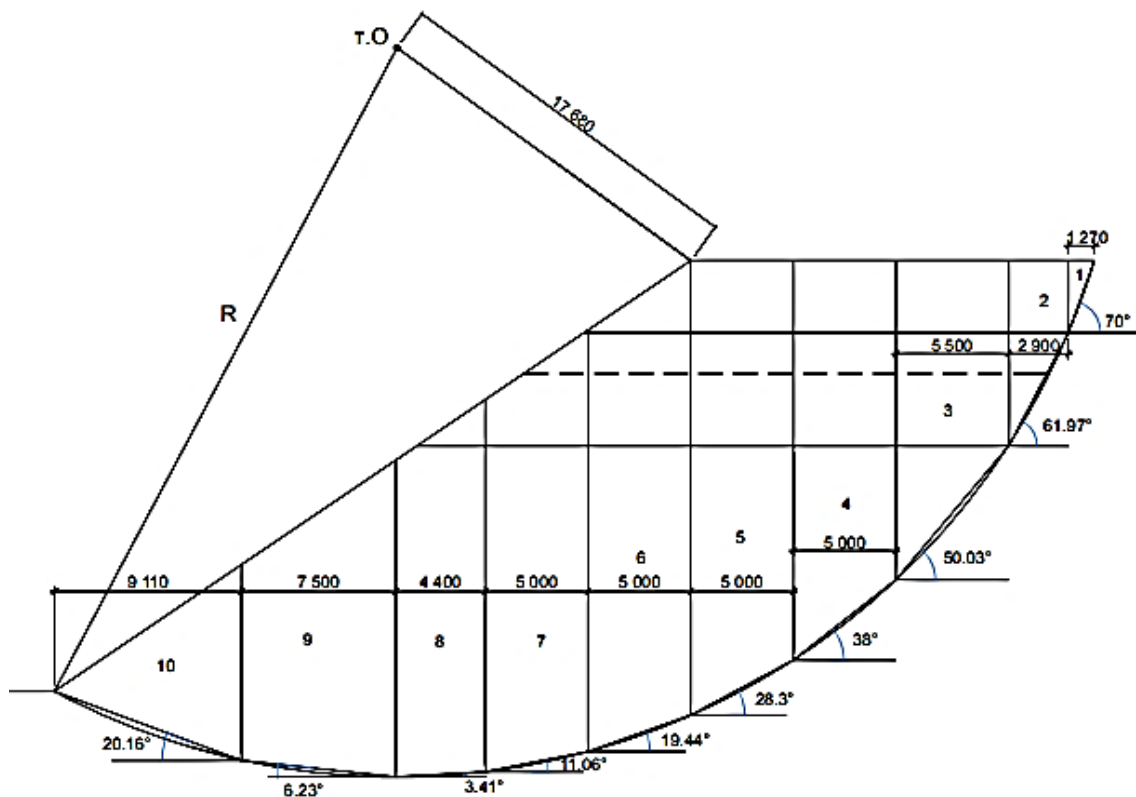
Розрахункова схема укосу для методу круглоциліндричних поверхонь
